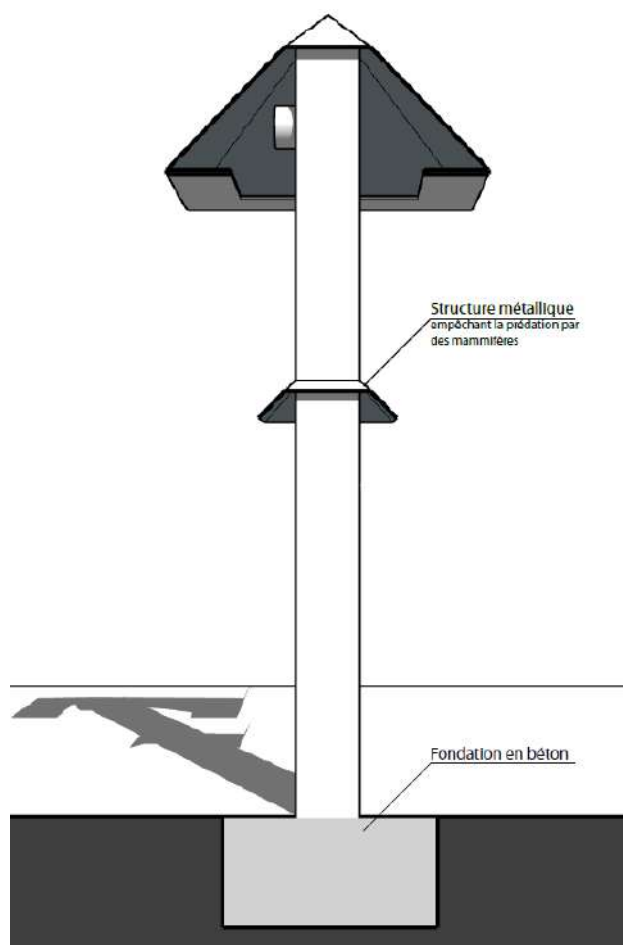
plan en coupe du mât permettant la compensation de la destruction du site de nidification du Rougequeue noir
